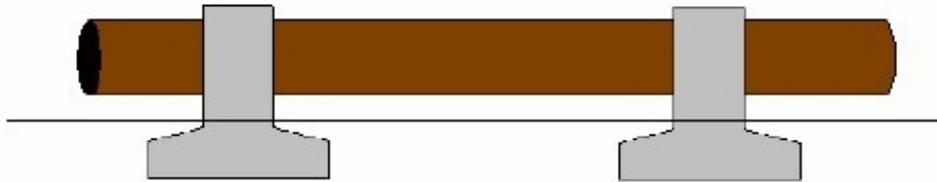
ESTRUTURA DE FIXAÇÃO DE UM DUTO APARENTE
